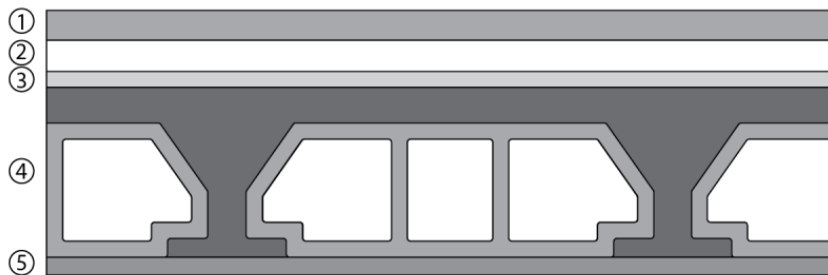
Section transversal d'un plancher a corps creux d'étage courant
